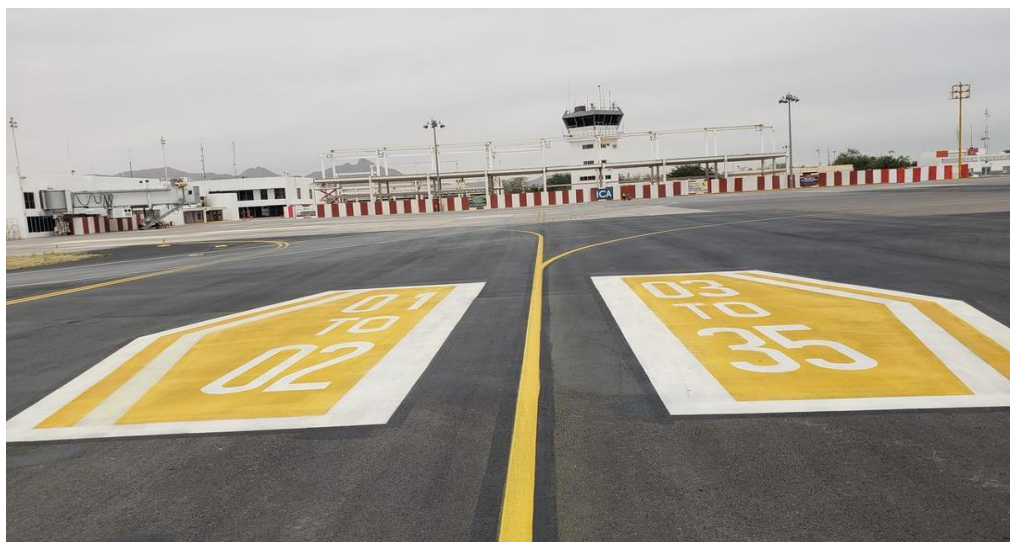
Reconstrucción calle de rodaje B, (autoría propia).
